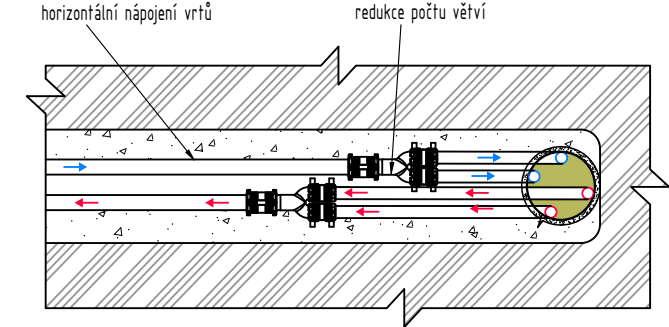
DETAIL VRATNÉHO U - KOLENA SE SEPARAČNÍ JÍMKOU
